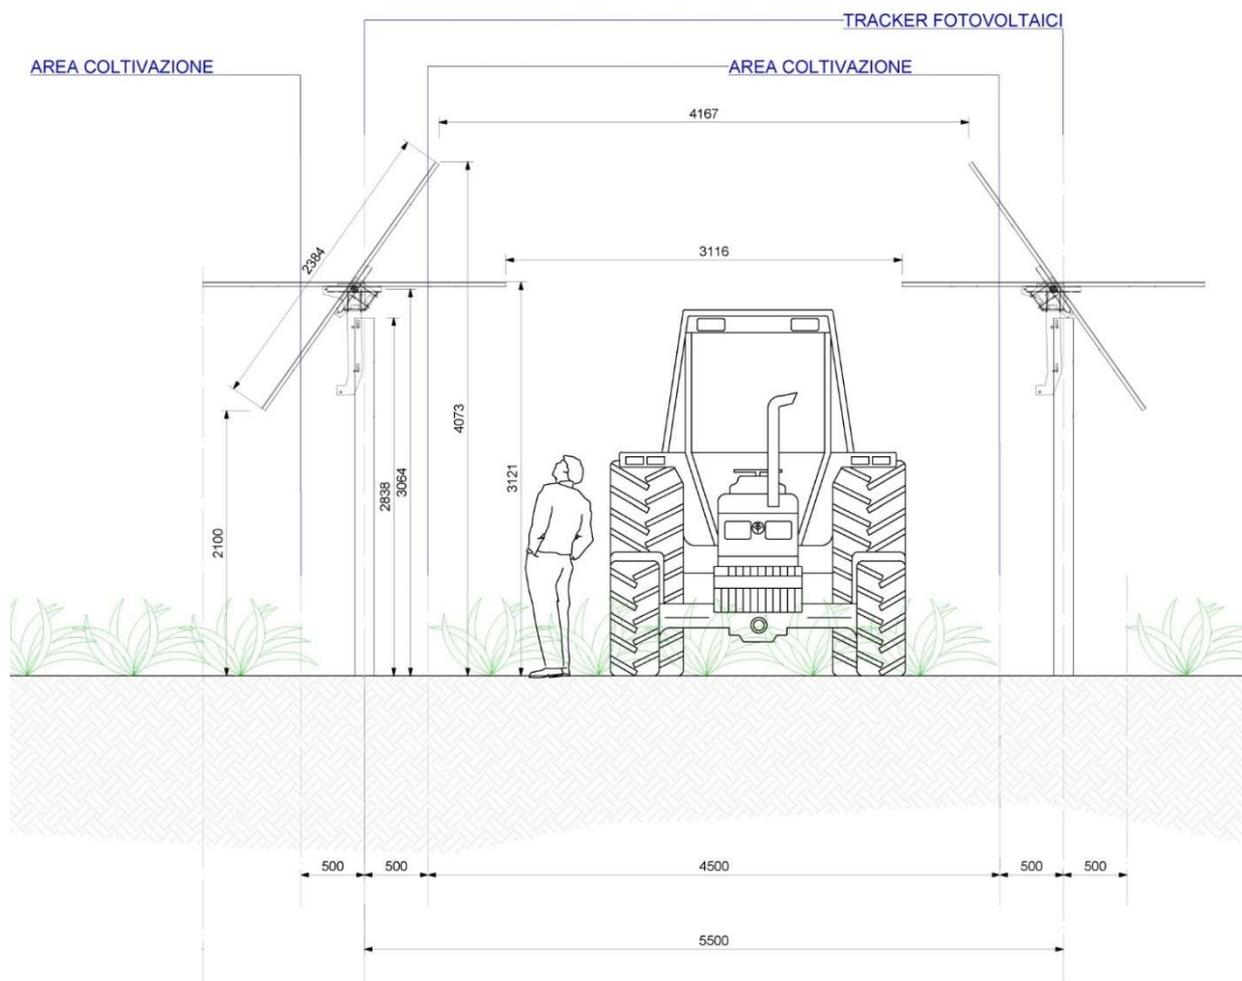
Dettaglio sezione tipo impianto agrivoltaico
